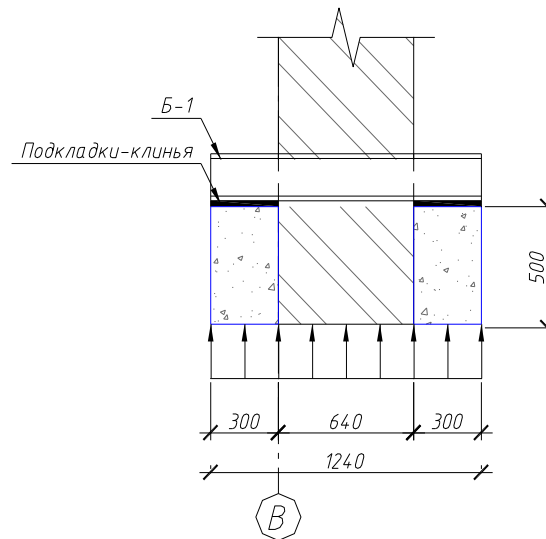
Схема посилення фундаменту по ряду «Б» облаштуванням приливів з бетону і облаштуванням розвантажуючих балок.
